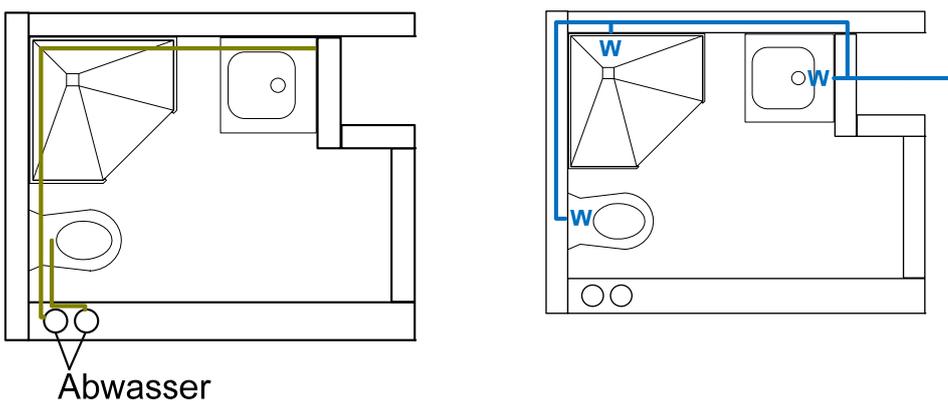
Nassraum mit Abwasser- und Wasserleitungen
